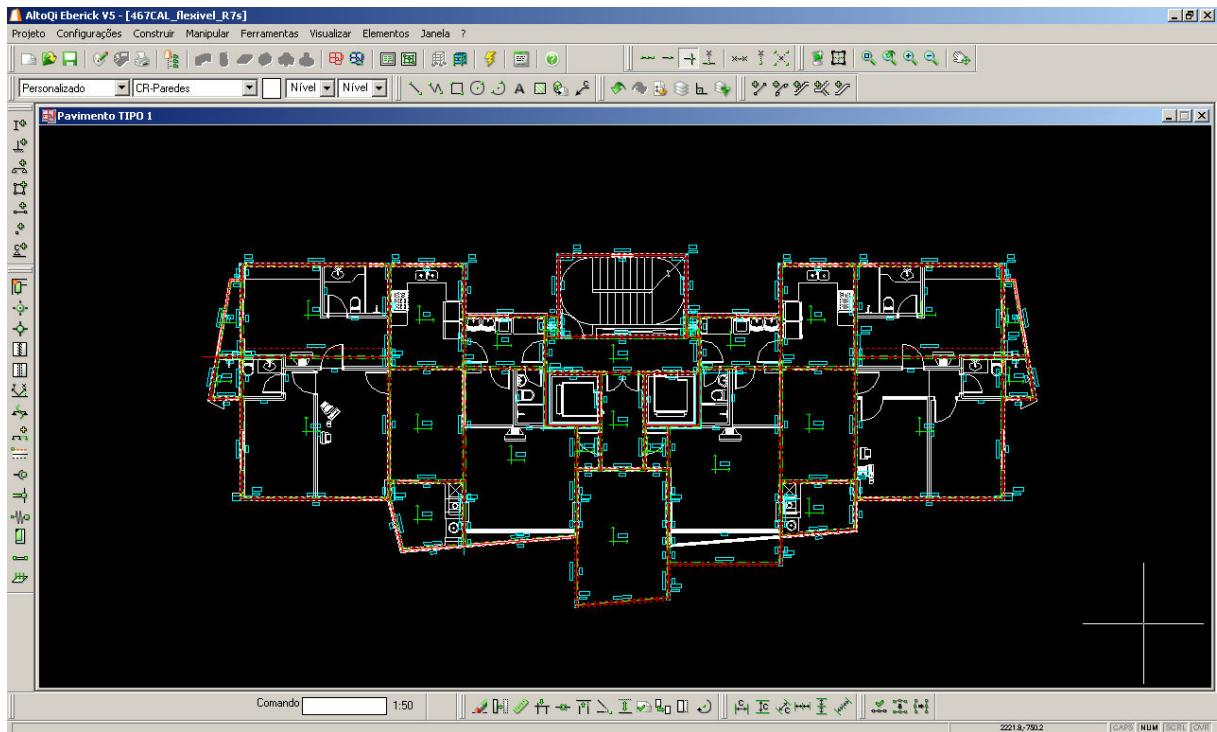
Lançamento dos elementos estruturais no plano 2D
